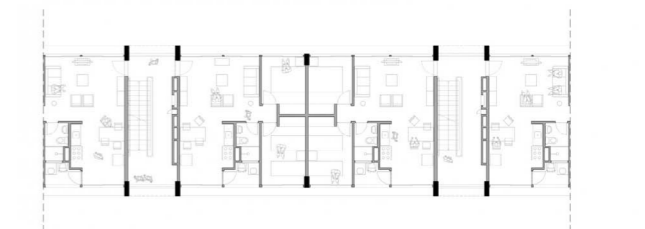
Tipologia de plantas. Fonte: MMBB.
